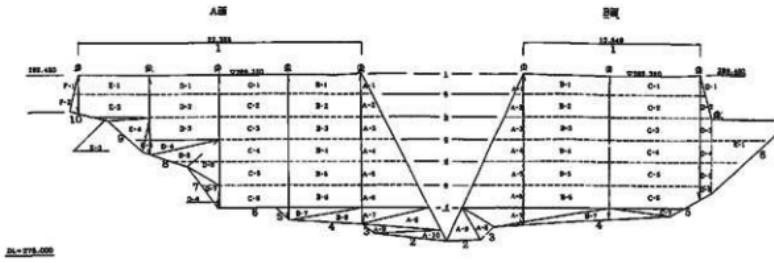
最終的な石垣解体、掘削範囲平面図
